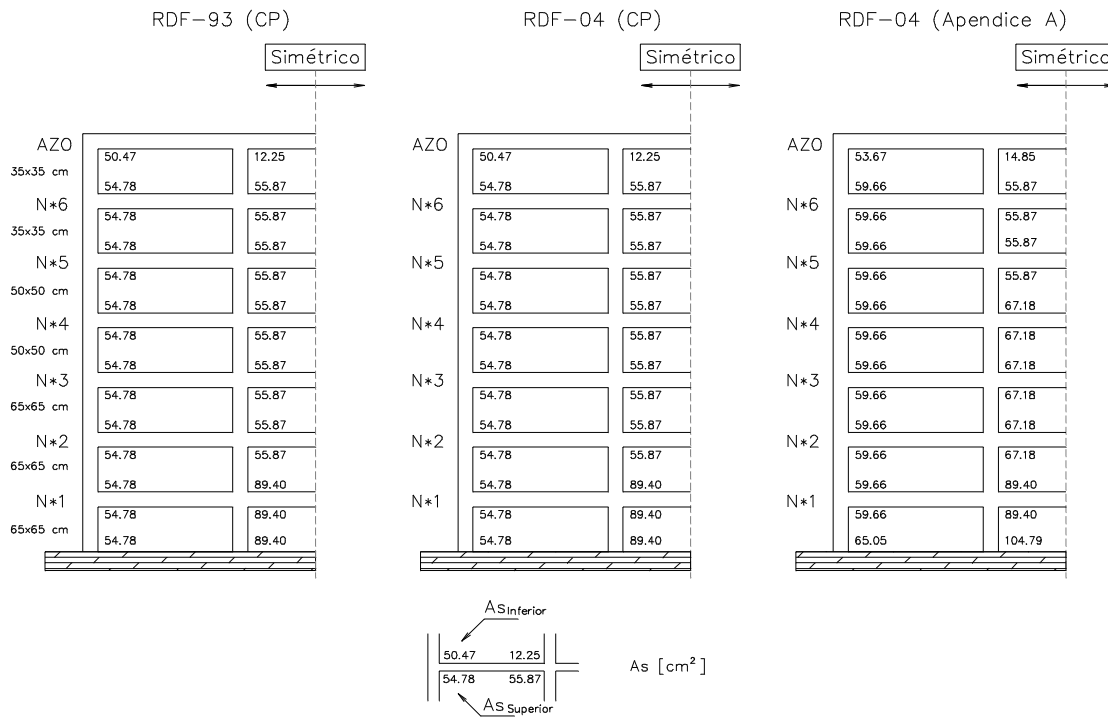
Comparación de áreas de acero de refuerzo longitudinal de las columnas del eje 2 de las estructuras diseñadas en zona II (RDF-93 y RDF-04)
